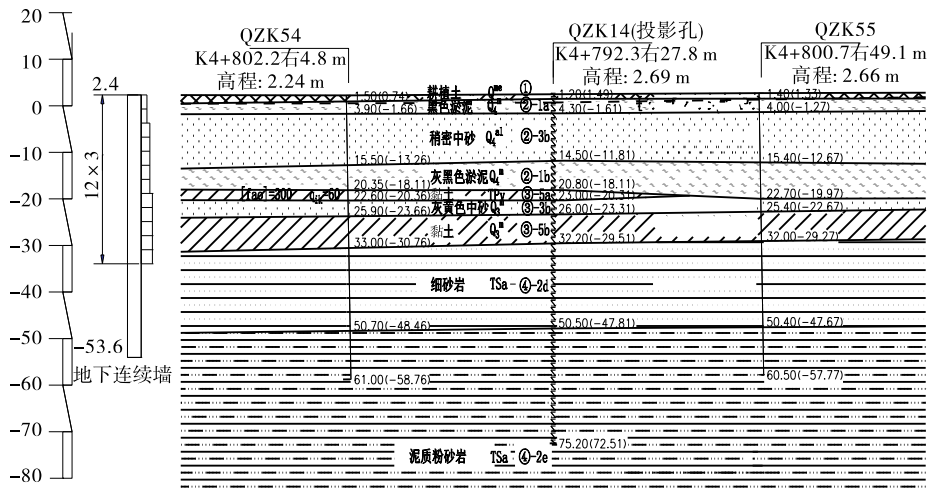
马普托大桥南锚碇地质横断面图(单位:m)
